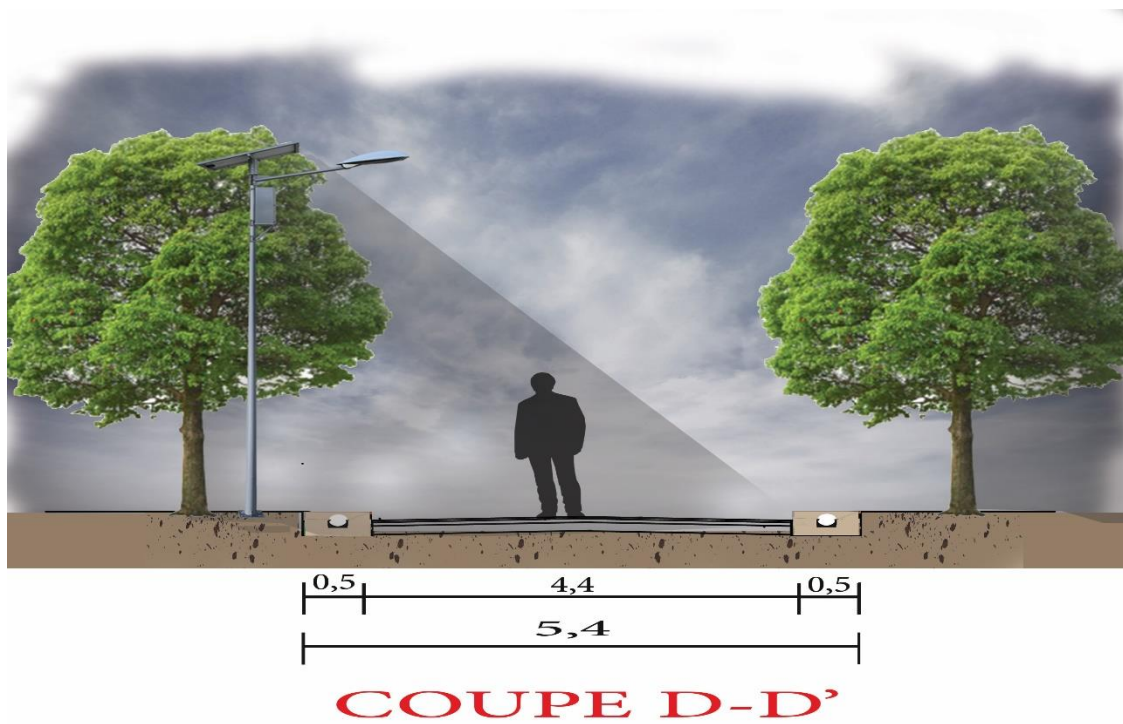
Coupe d'une voie secondaire. Source : Auteurs
